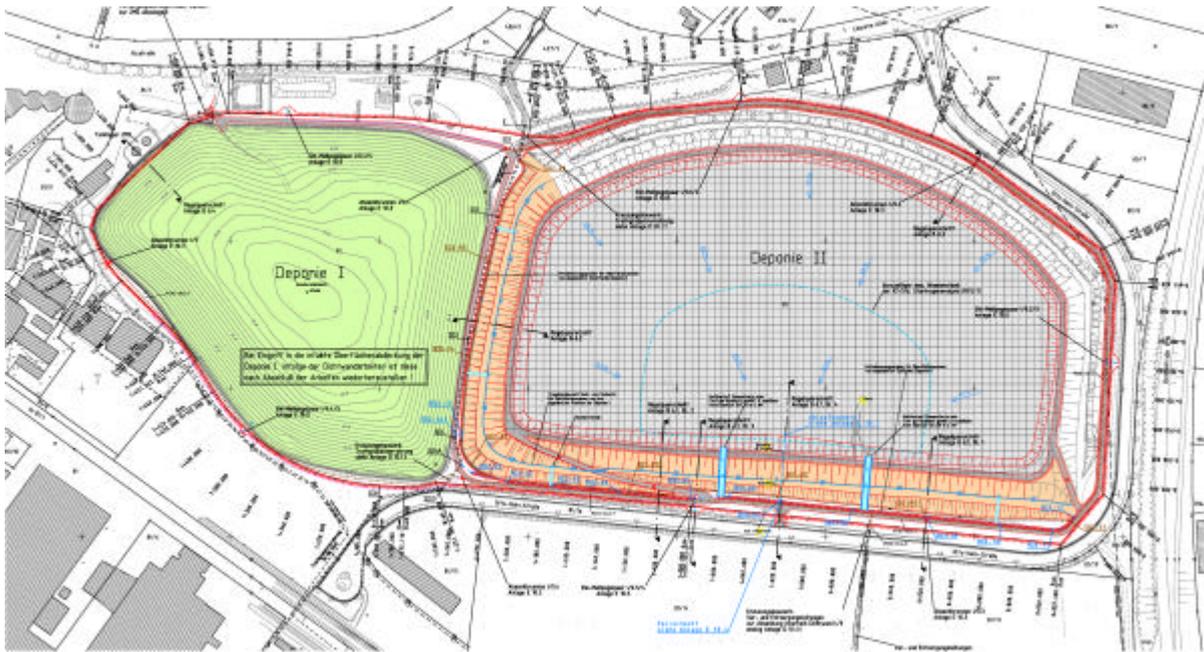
Lageplan Deponie I/II (Ausführungsstand)
